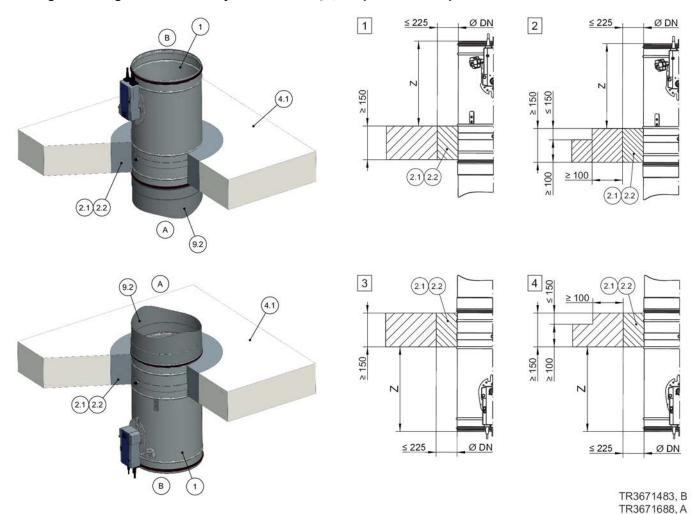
Montagem em argamassa numa laje de teto maciça, suspensa ou em pé
